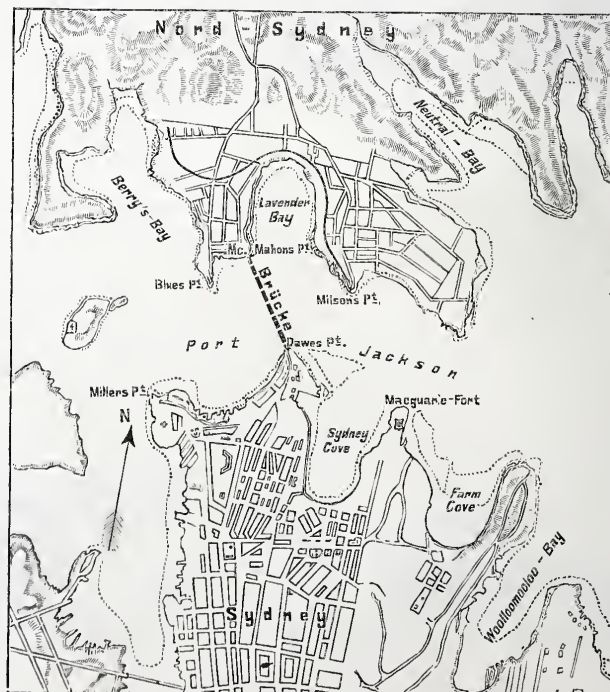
Lageplan. (Maßstab rd. 1 : 40 000.)
